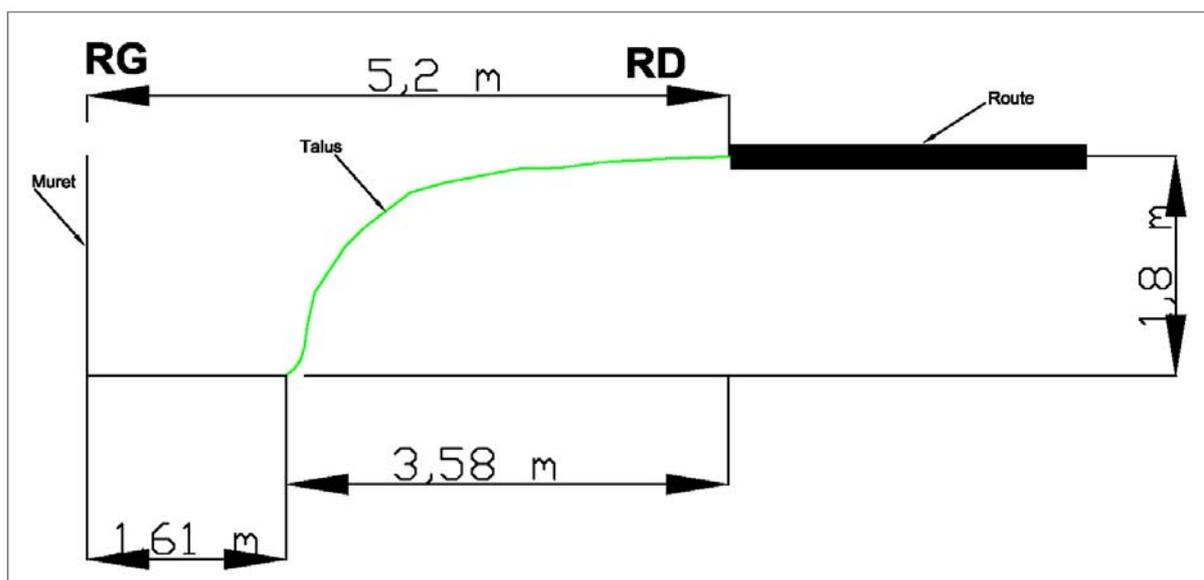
Schéma d'un profil transversal – Rive droite en pente raide -Schéma d'un profil transversal – Rive droite en pente raide -
